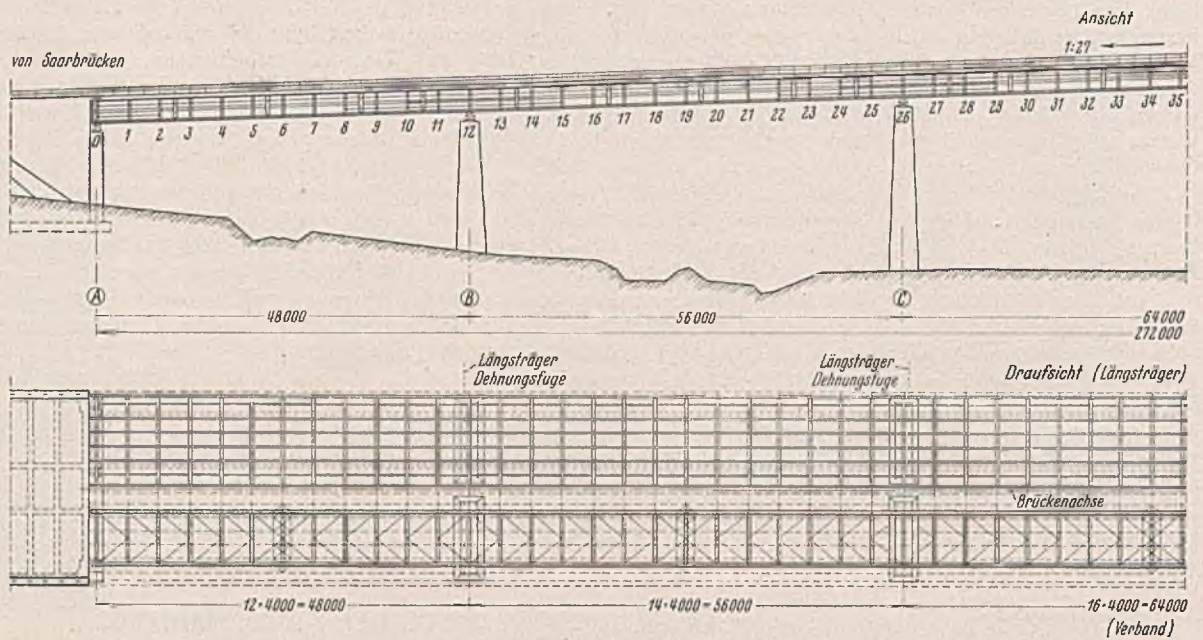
Längsschnitt und Grundriß der Überbauten.
